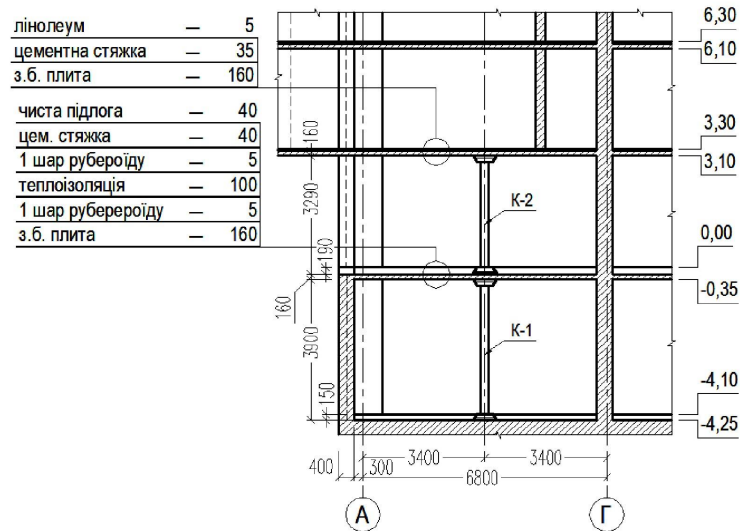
План і переріз ділянки будинку з підсилюваним міжповерховим перекриттям на відм. 3,30
